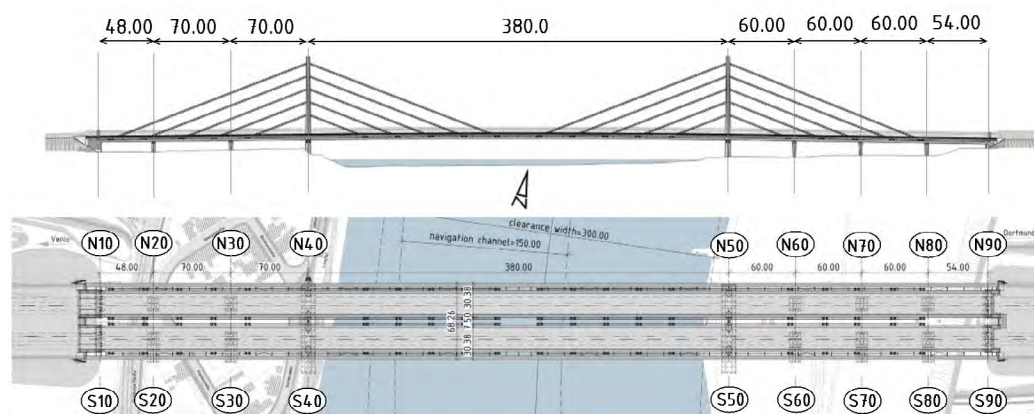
Alzado y planta del nuevo puente de Duisburg-Neuenkamp (LAP).
